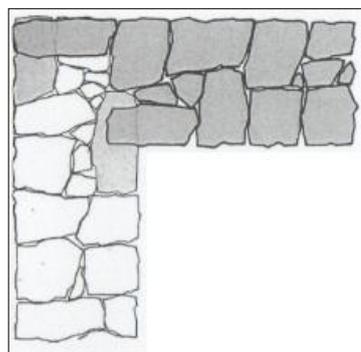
Différents types de pose de pierres. village Djebba, Bejaia. (Source : auteur).
